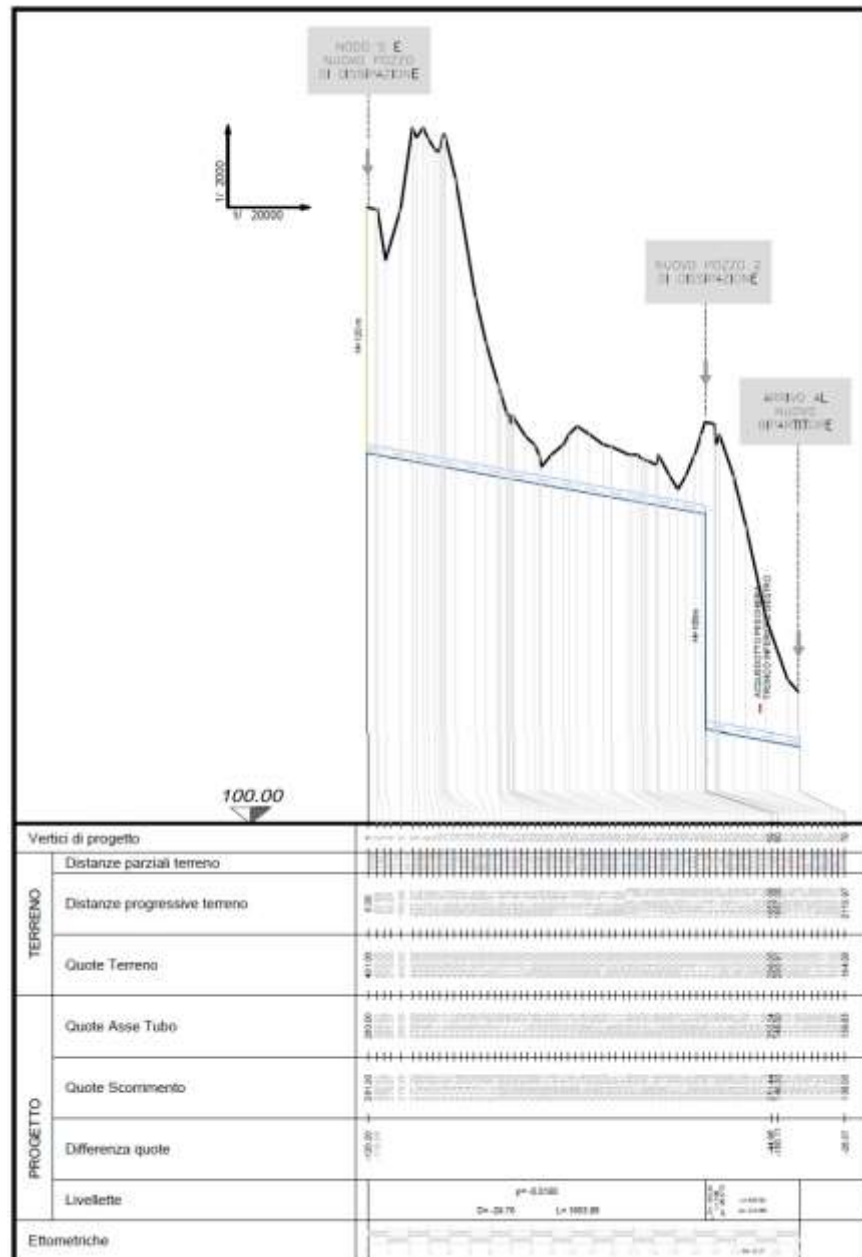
Planimetria e sezione di dettaglio del by-pass della centrale di Salisano
